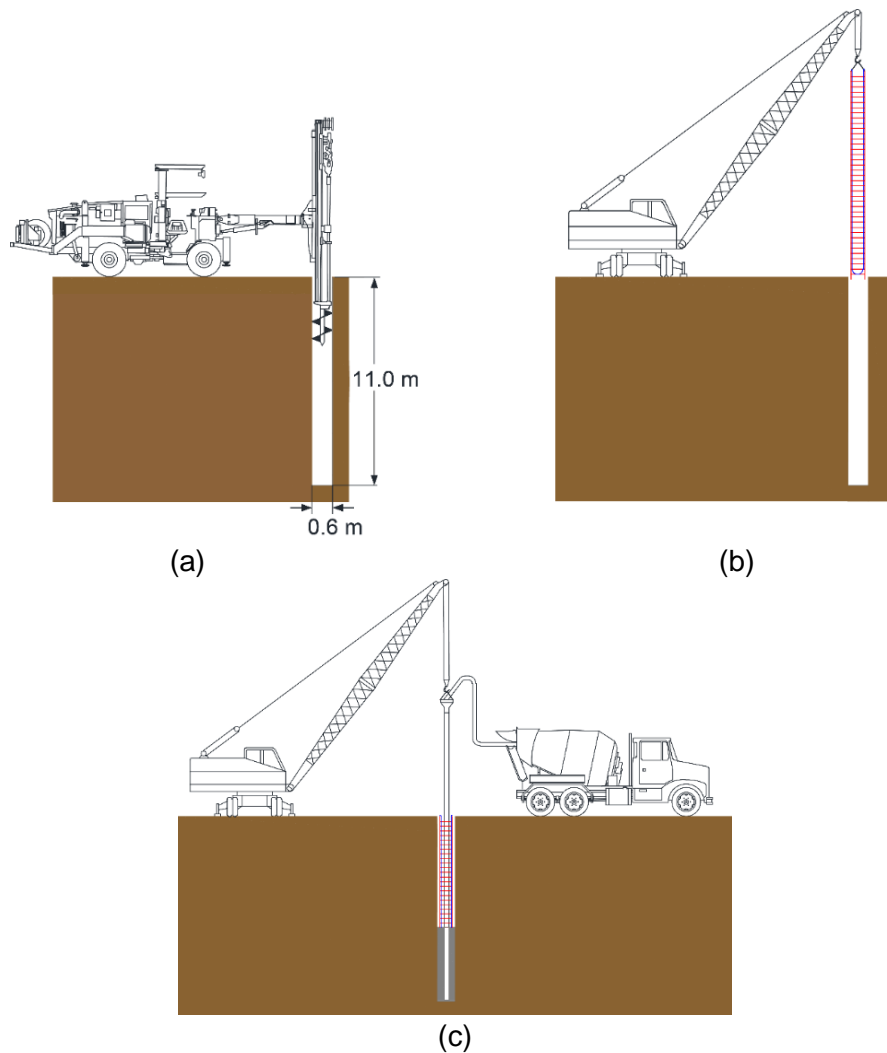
Procedimiento constructivo: (a) perforación del barreno, (b) colocación del armado y (c) colado de la pila
